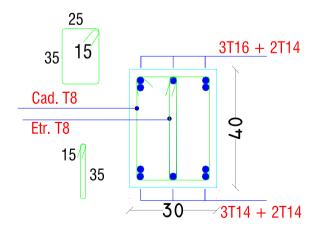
Ferraillage des poutres principales pour Etage 4,5 et 6.
